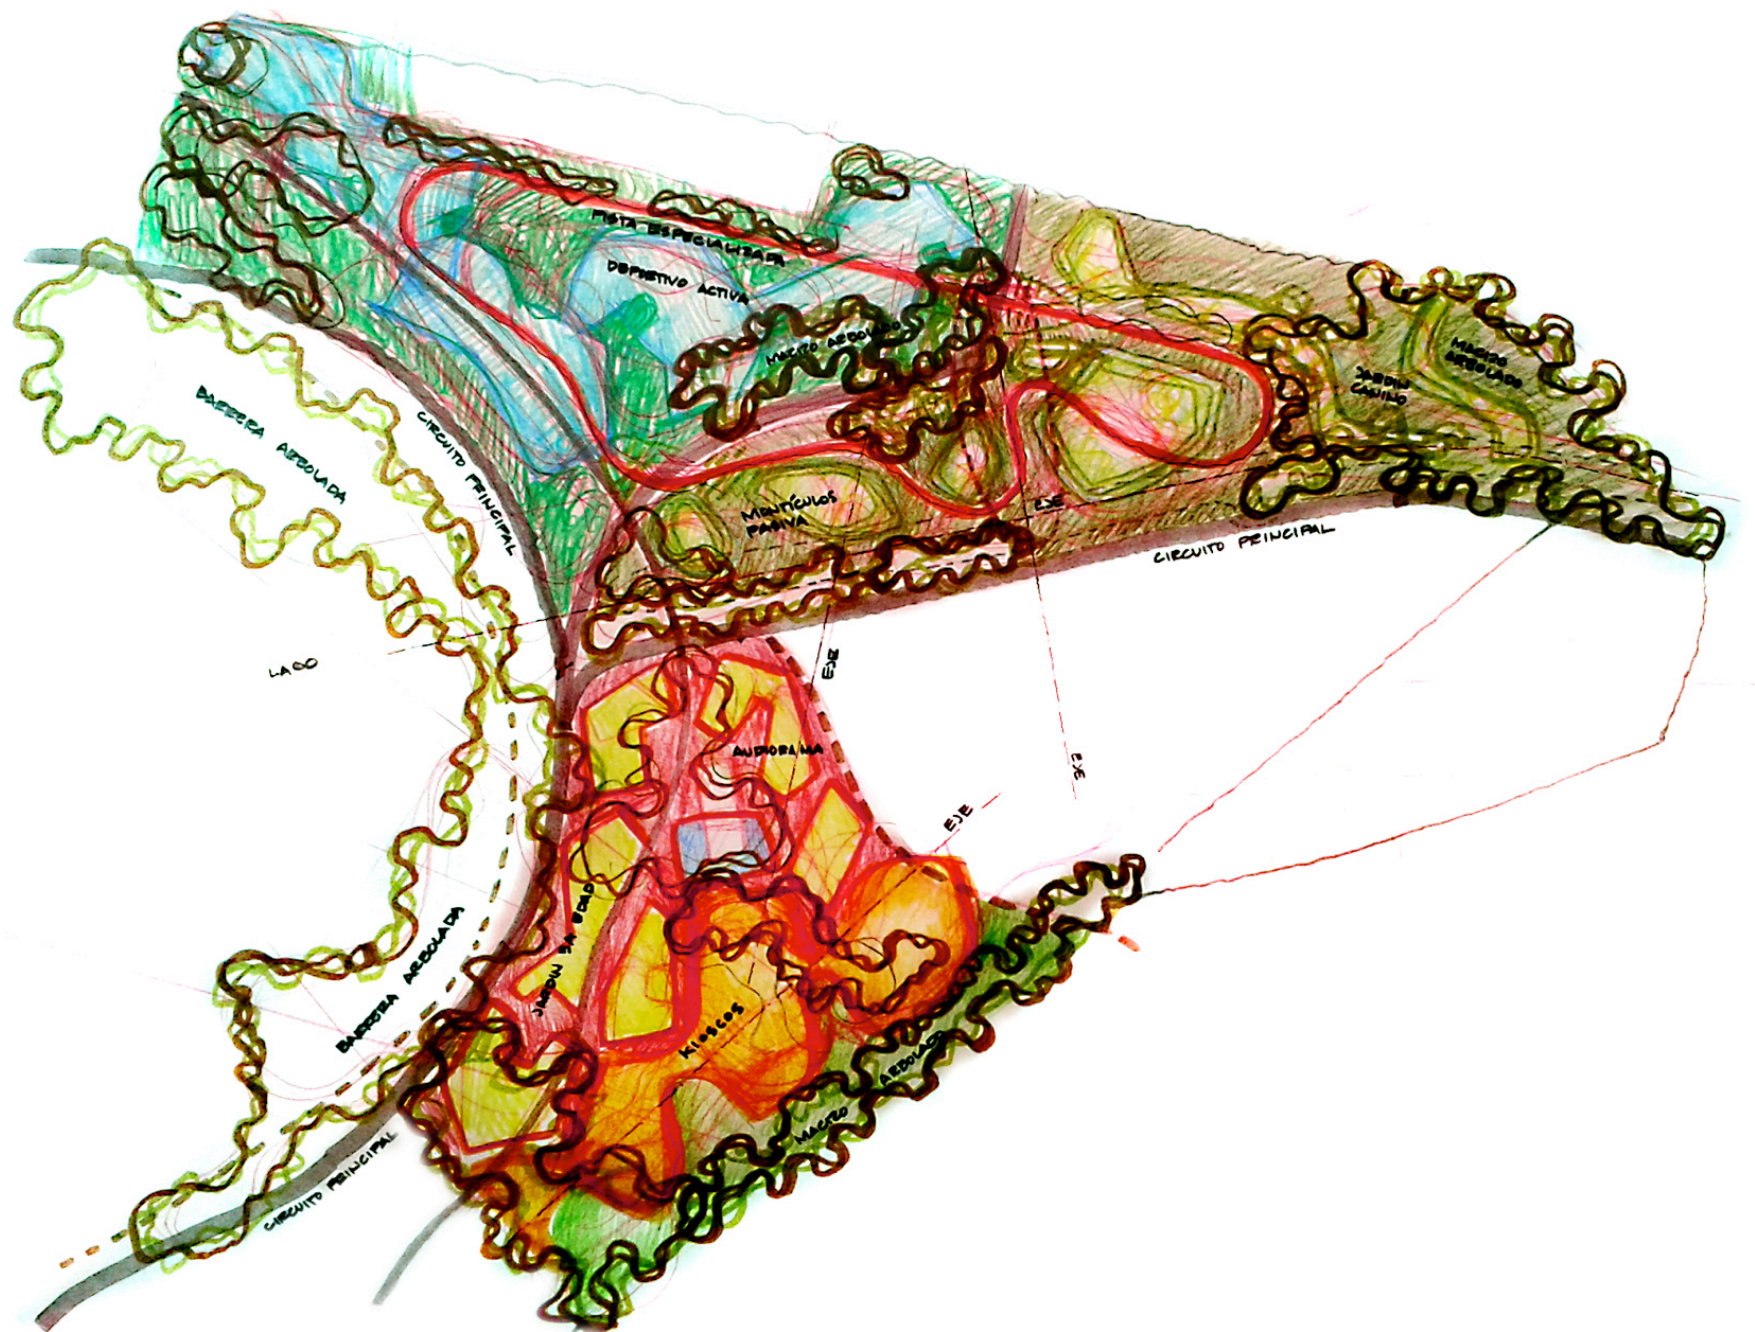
BSJA, Zona IV. Primer boceto del concepto de la estructura paisajística a partir de los requerimientos del Plan Maestro.
